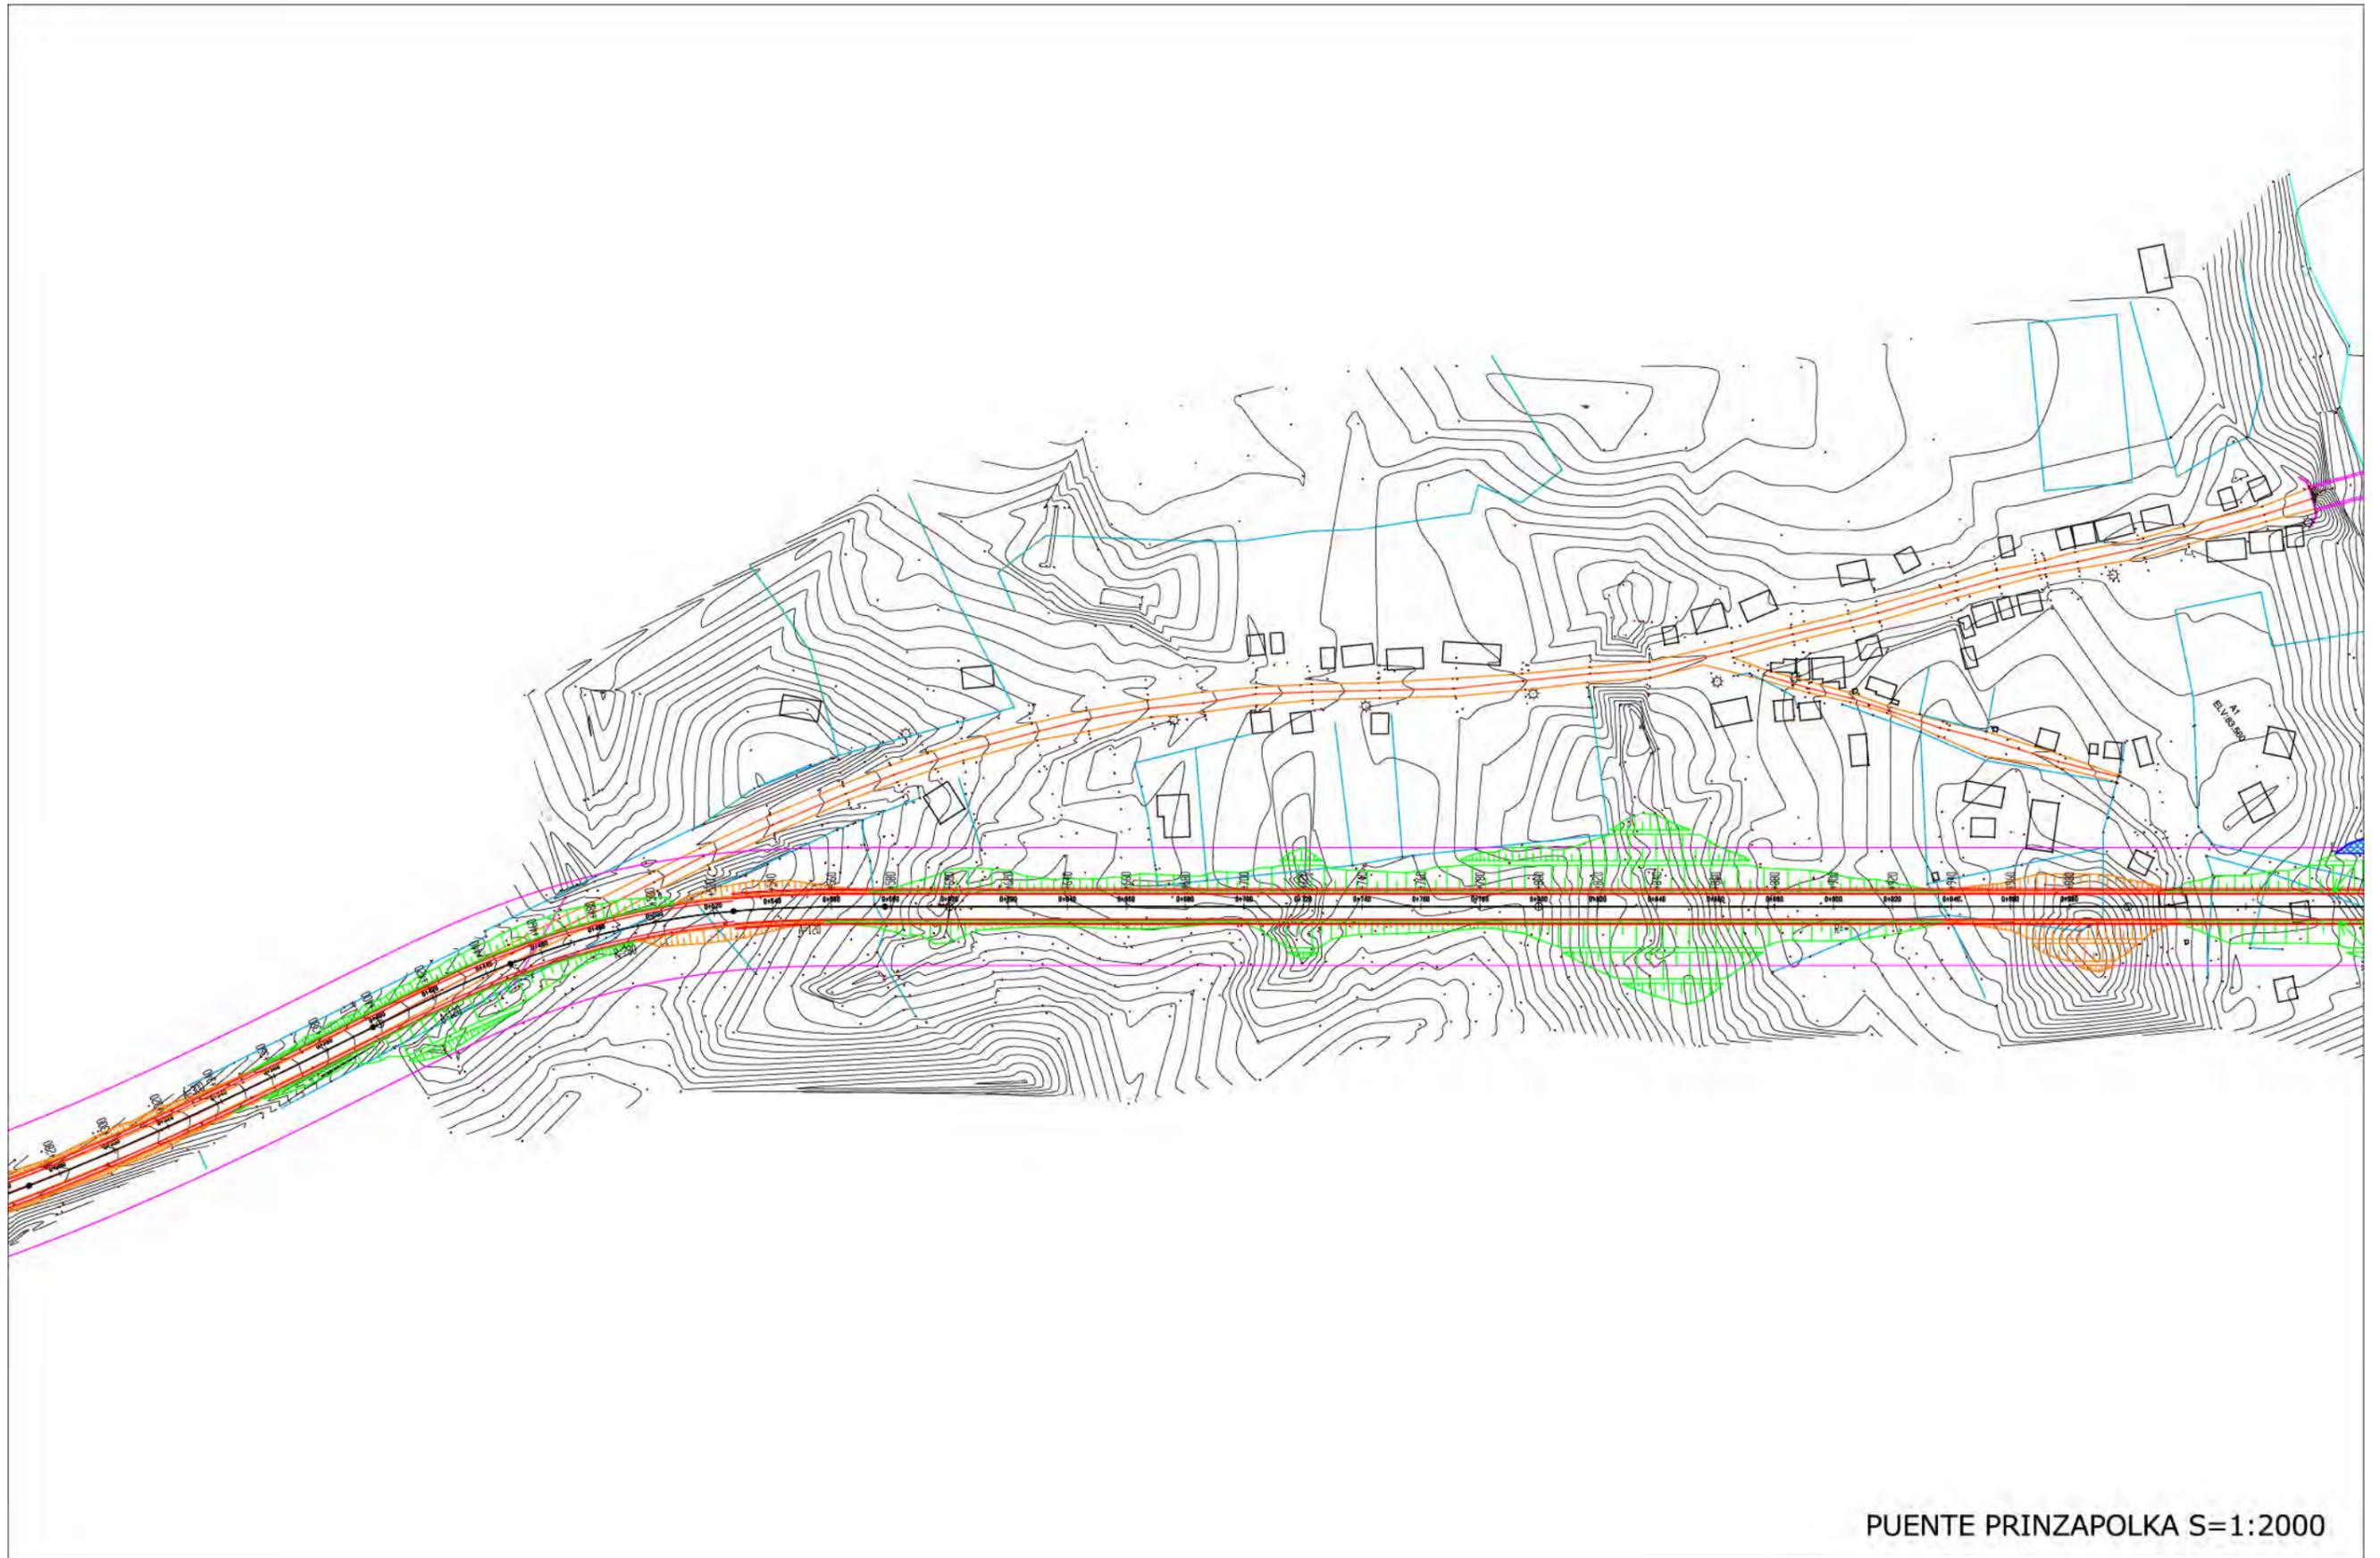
架橋位置平面図 (プリンサポルカ橋 (1/2))
